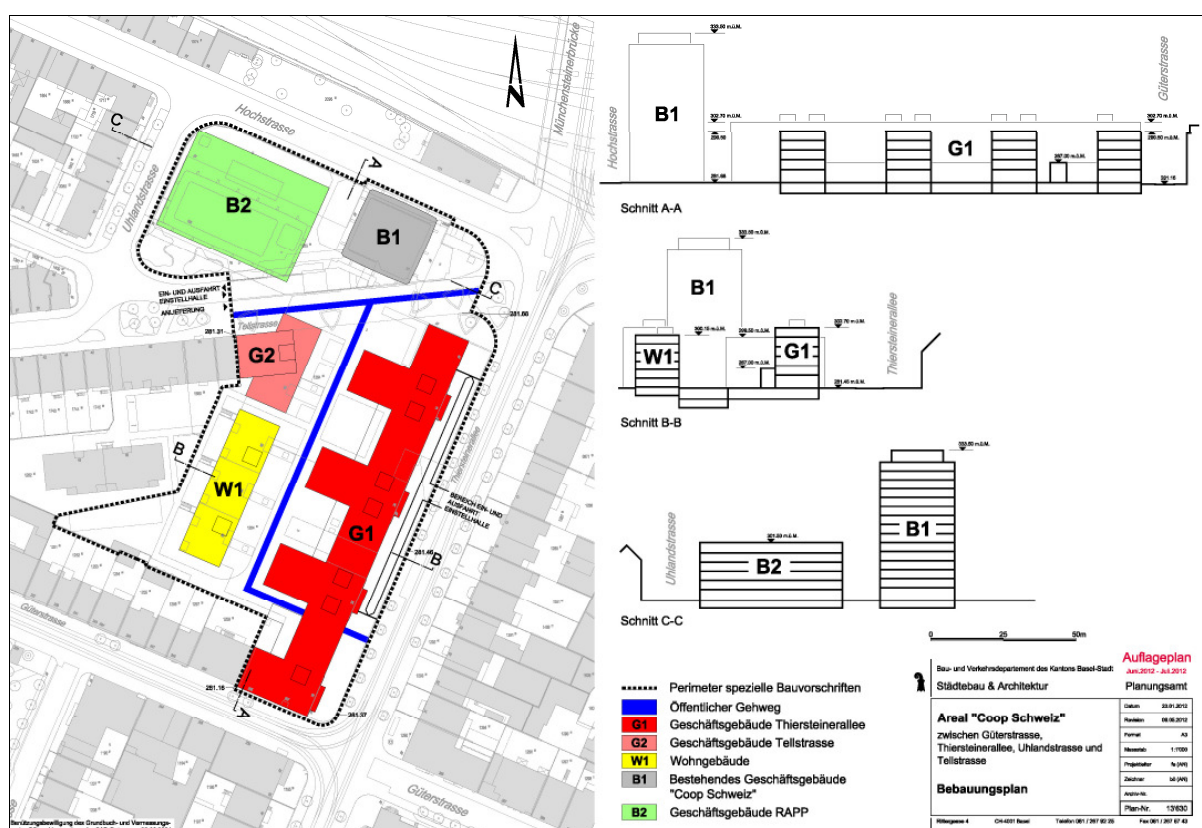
Neuer Bebauungsplan Nr. 144, Plan Nr. 13'360 aus dem Jahr 2012. (Ohne Massstab, Plan genordet)
